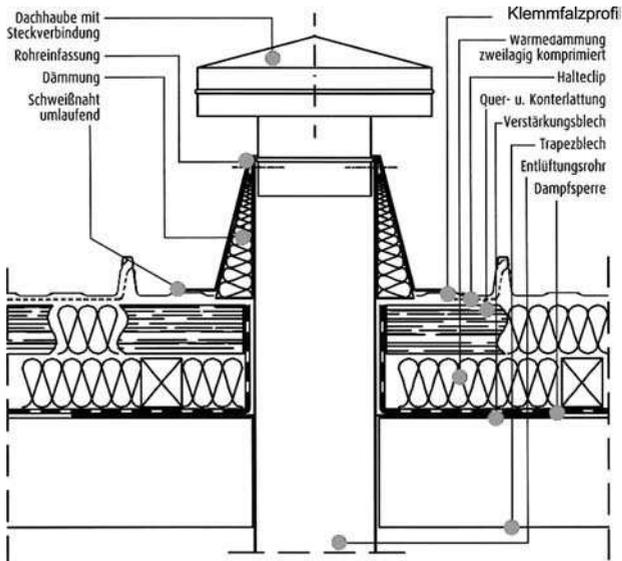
Eingeschweißte Rohrdurchführung bei Klemmfalzprofildeckung aus Aluminium
